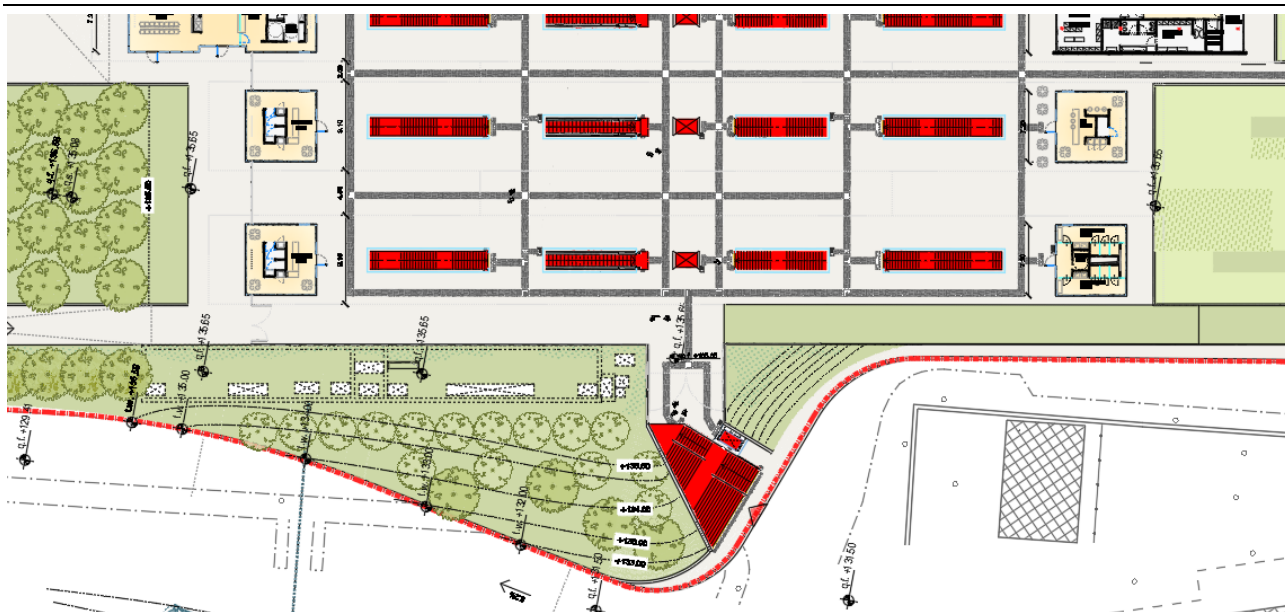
Planimetria di inquadramento del nuovo ingresso ovest.
